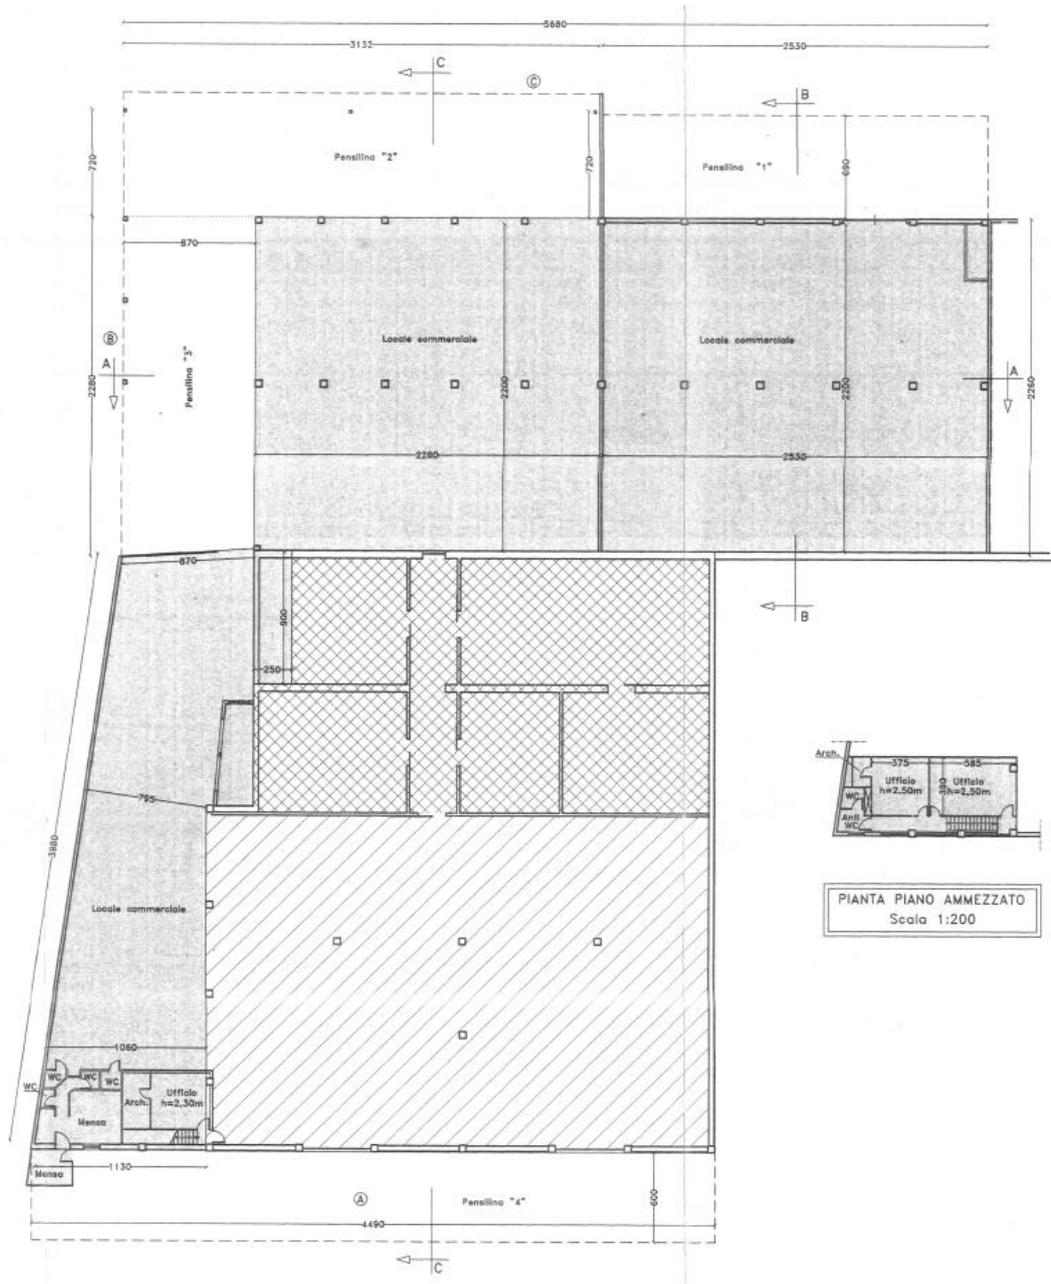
Pianta piano terra e ammezzato – Richiesta concessione edilizia a sanatoria
